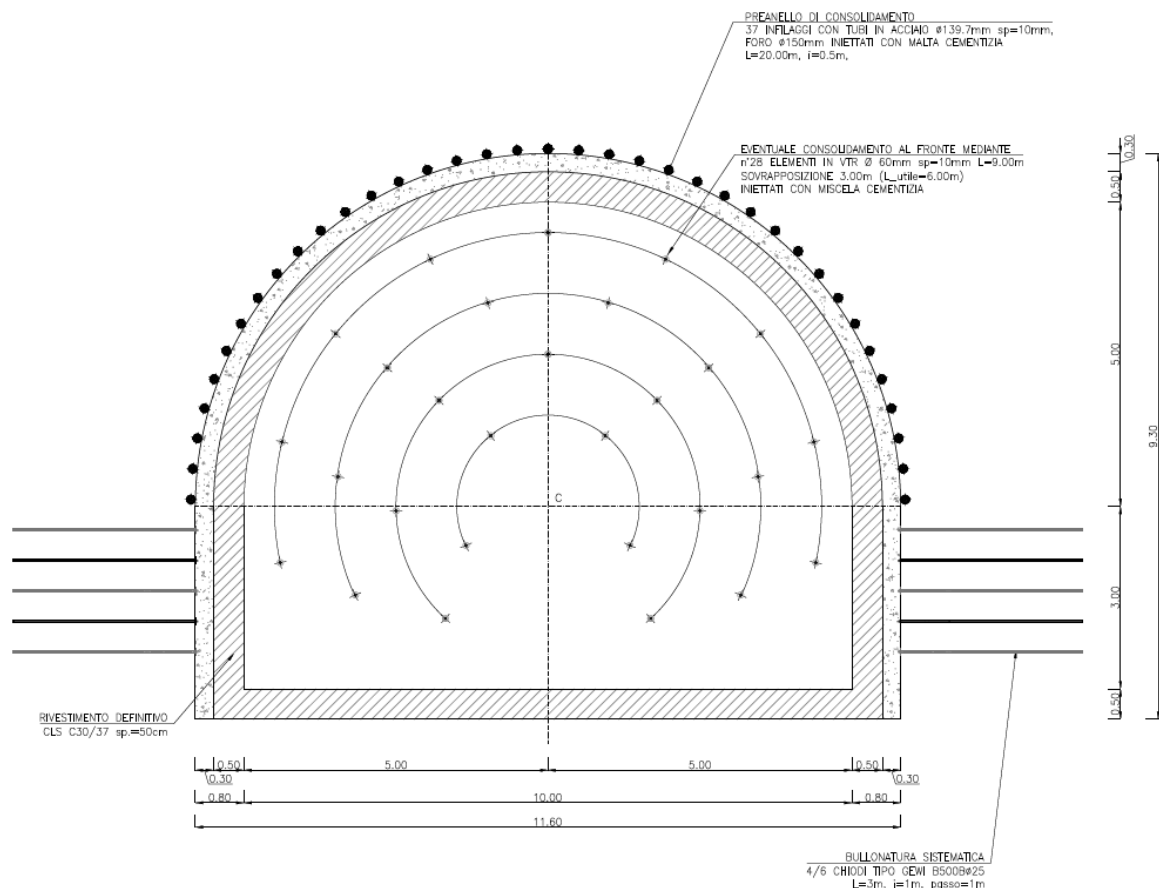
Sezione tipo DImb: geometria del cavo e interventi di sostegno, sezione trasversale
